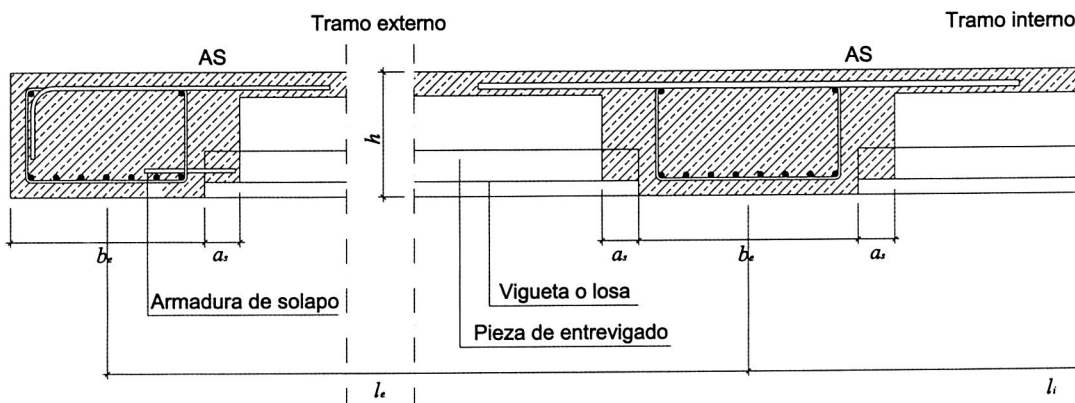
Enlaces por solape de forjado de viguetas o losas sobre elementos de hormigón armado: vigas planas, vigas resaltadas o muros
